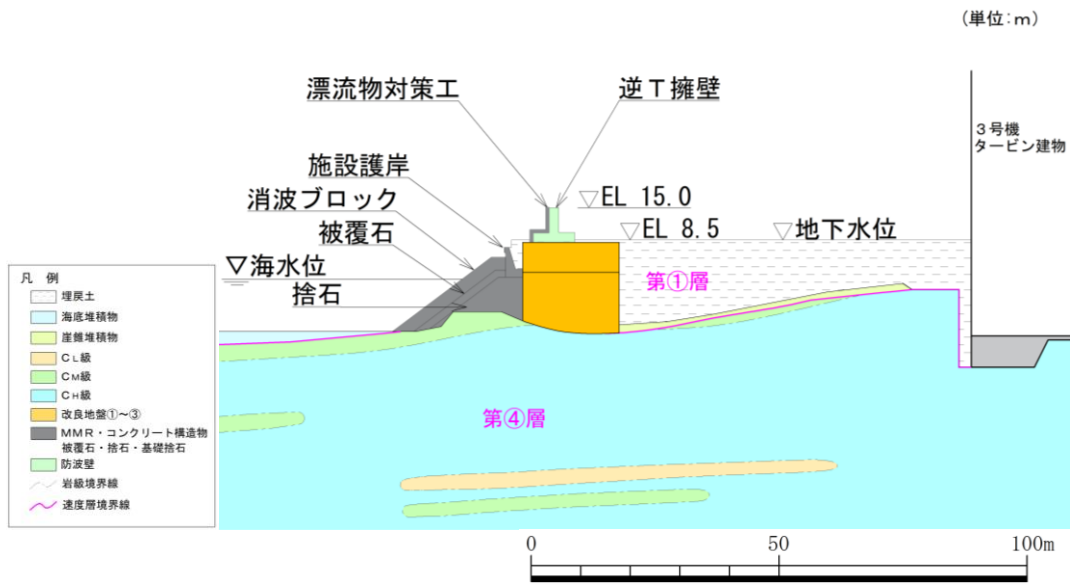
防波壁 (逆 T 擁壁) の横断面図 (⑤-⑤断面)
